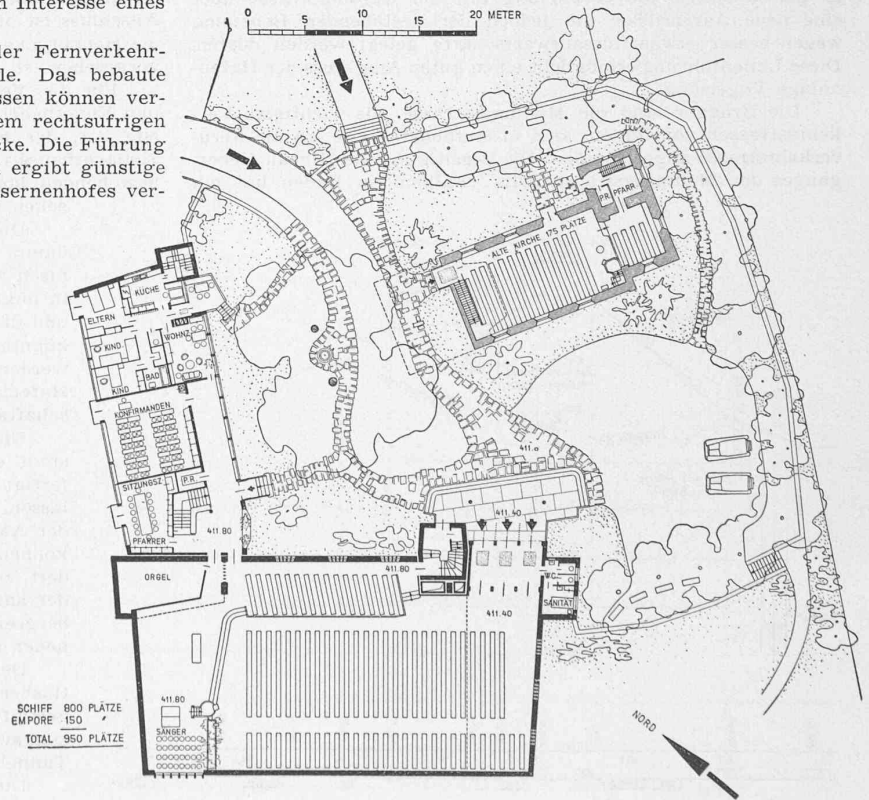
Lageplan und Grundriss 1:600 der alten und der neuen Kirche samt Annexflügel
